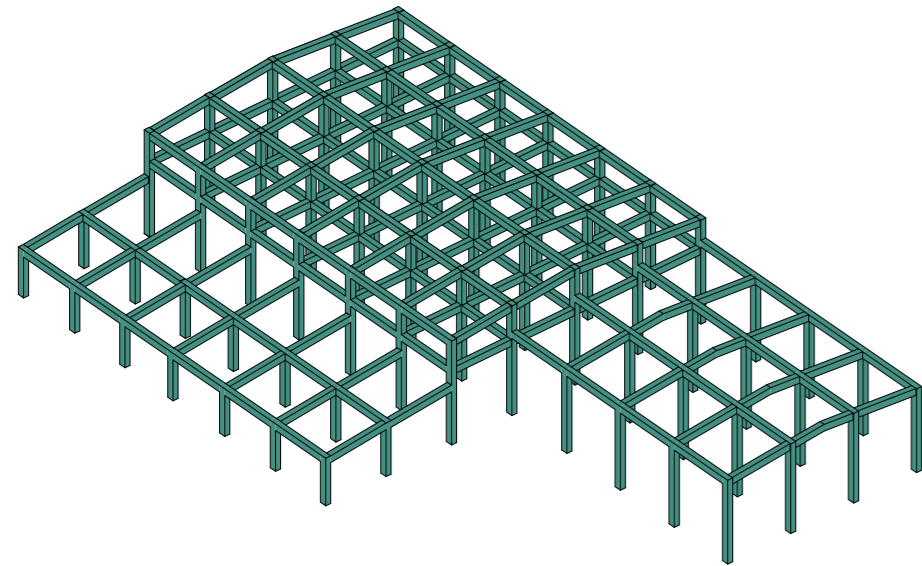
Estructura actual de la planta de faenamiento. Fuente: Autoría propia.
